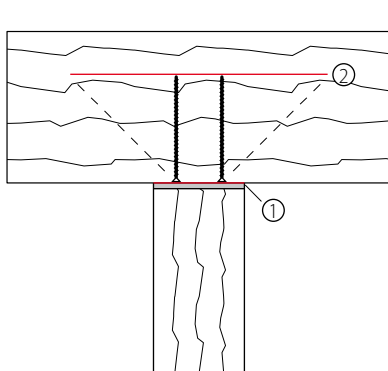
Nachweisstellen bei Verstärkung eines Holzquerschnittes mit Holzschrauben
